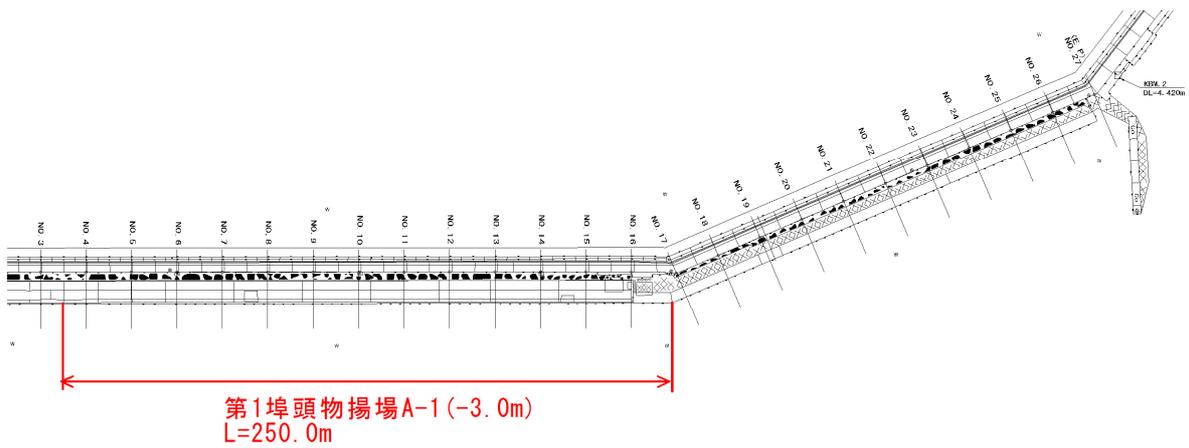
No.25 大洗港区_第1埠頭地区A物揚場 (-3m) の平面図 (被災前)
